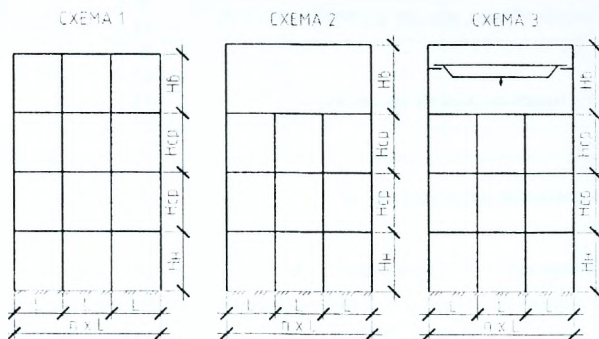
Схемы поперечных сечений многоэтажных зданий
